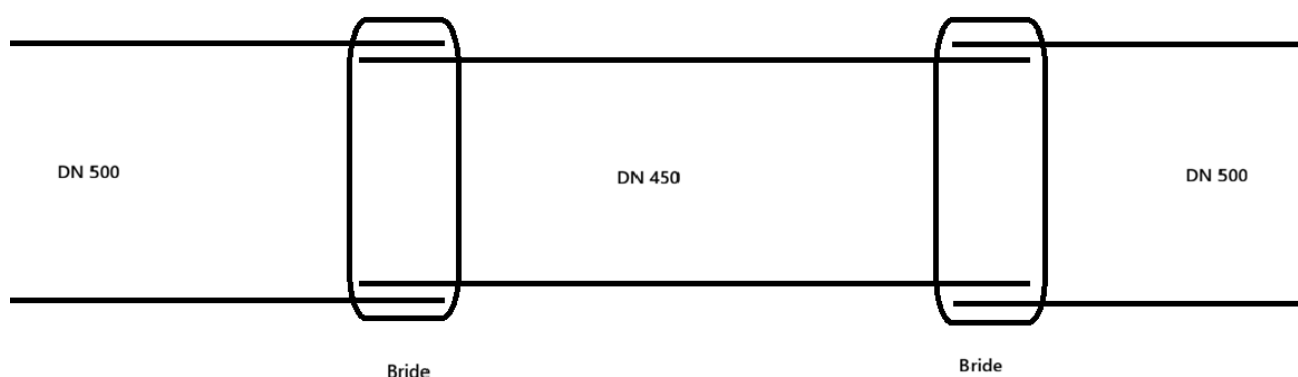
SCHEMA DE LA REPARATION DE LA CONDUITE FORCEE
